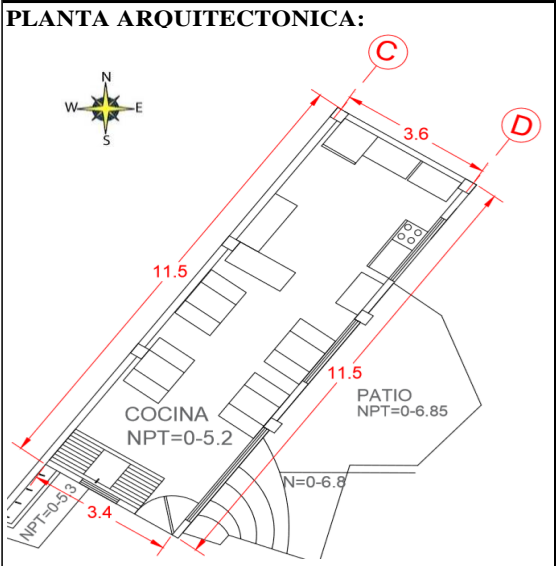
Planta arquitectónica media segundo nivel. Elaboración propia
